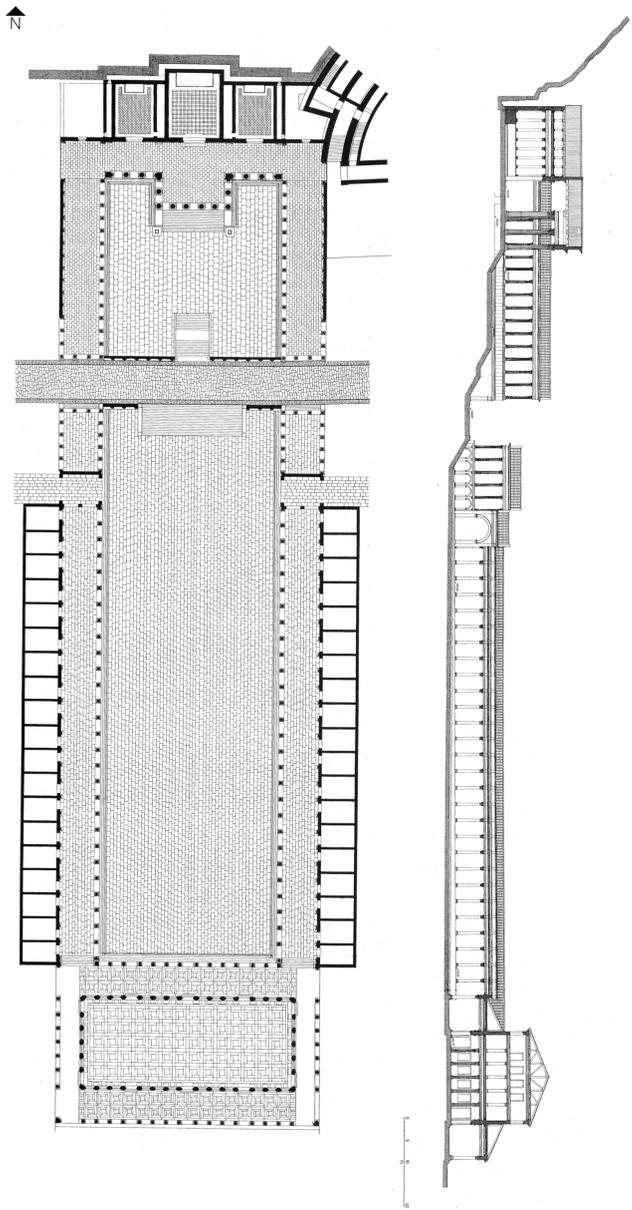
Foro di Brescia. Sezione ricostruttiva e pianta (da Rossi 1998).
